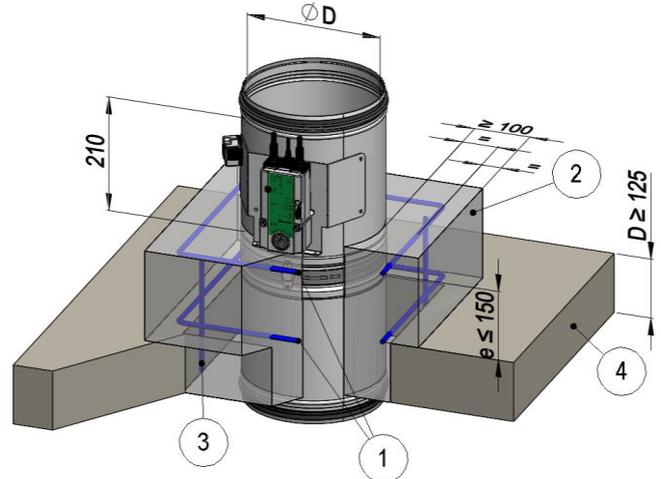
BSK-RPR mit Betonsockel stehend auf massiven Decken
